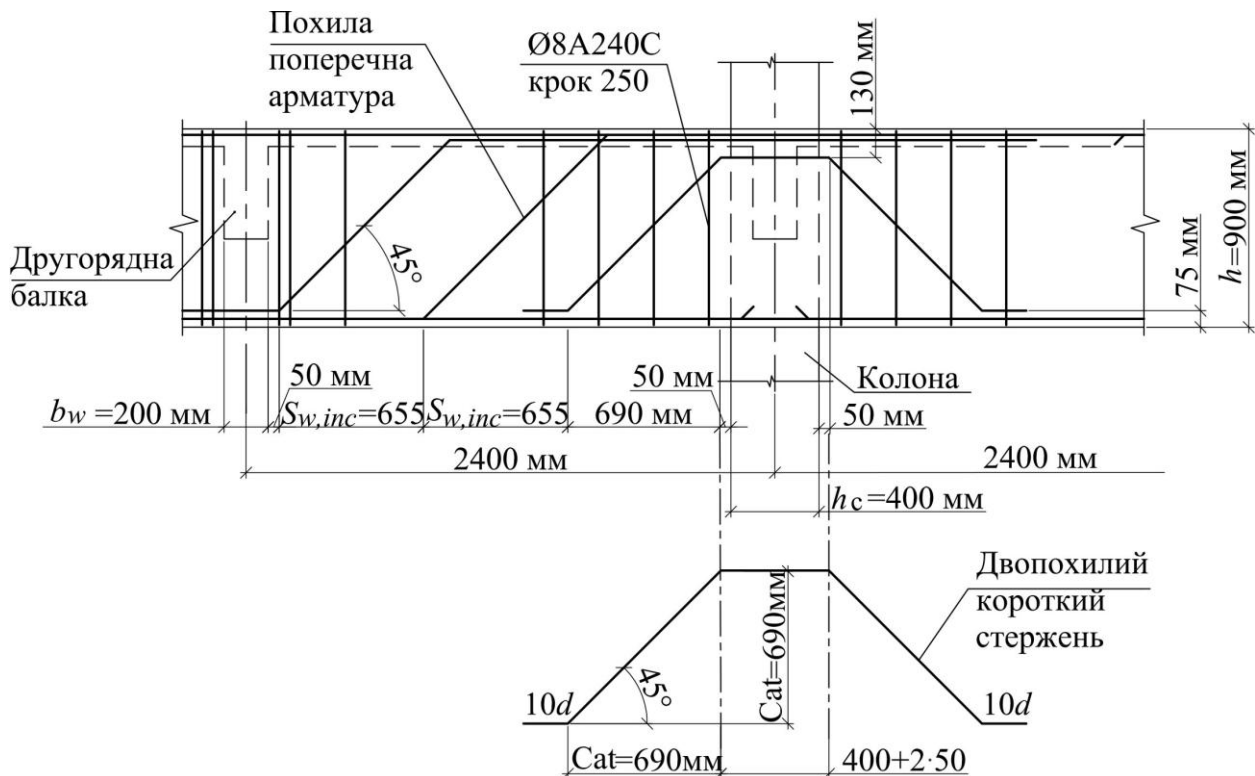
Схема армування балки похилою та вертикальною поперечною арматурою
